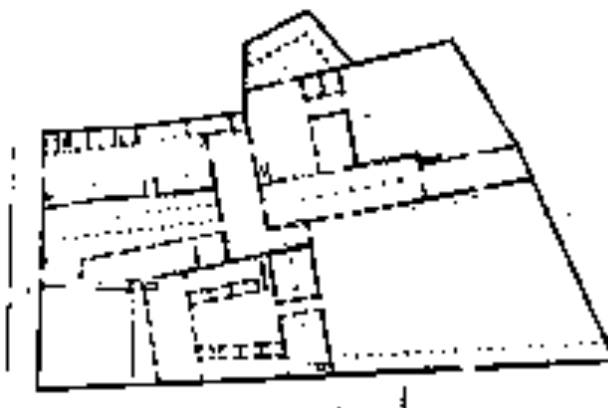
Planta del Proyecto de Matadero de vacas de la Puerta de Toledo. Arquitecto: Juan José Sánchez Pescador, 1841 (AVM. 0'59-31-32)
